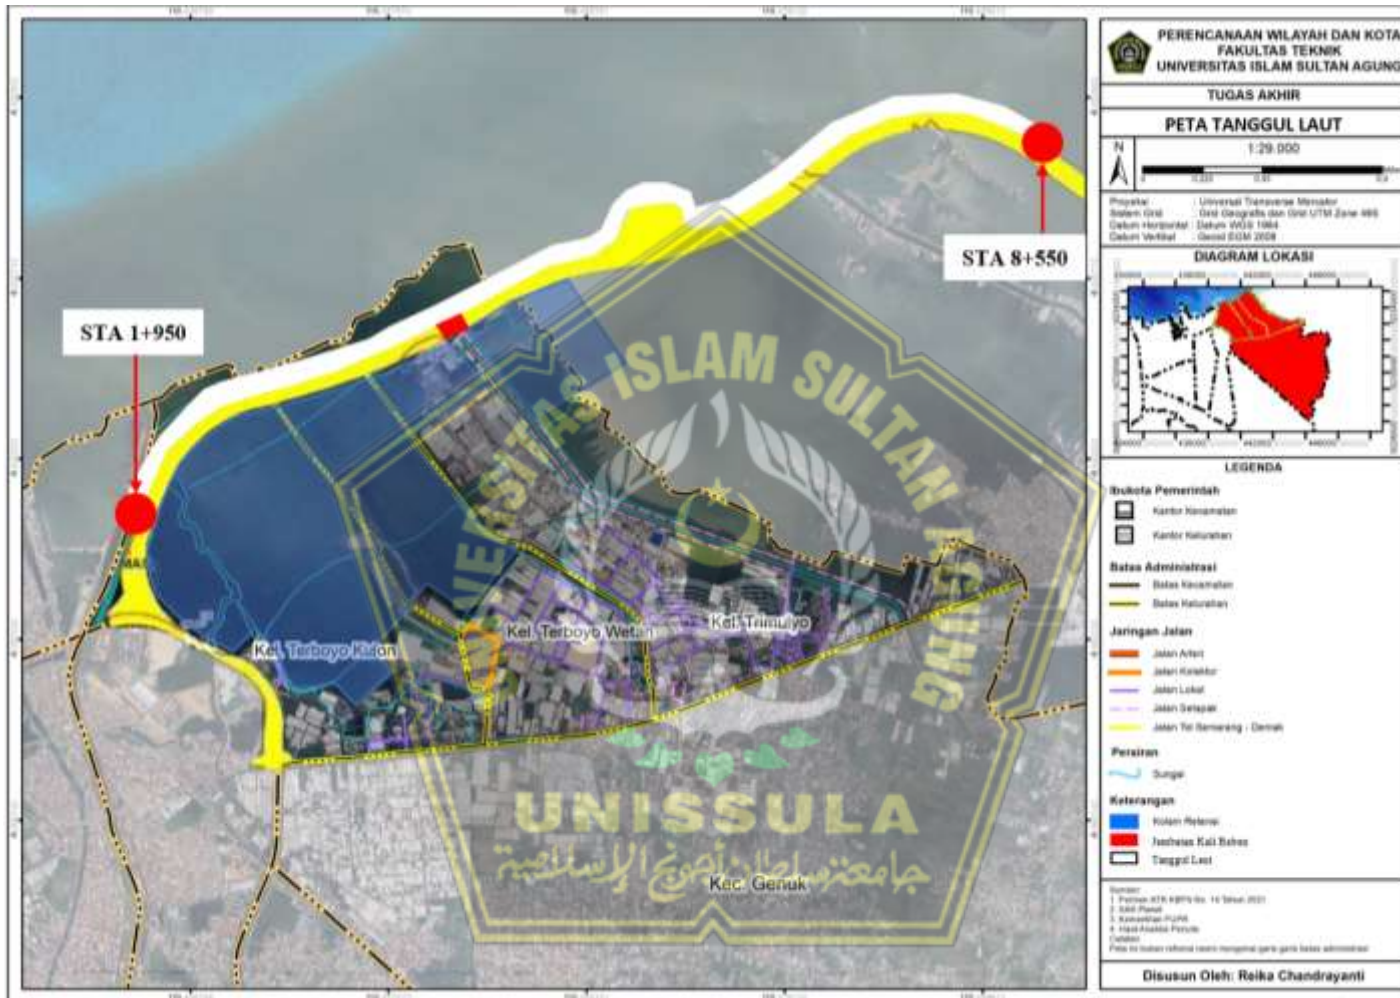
Desain Tanggul Laut Alternatif 2B
